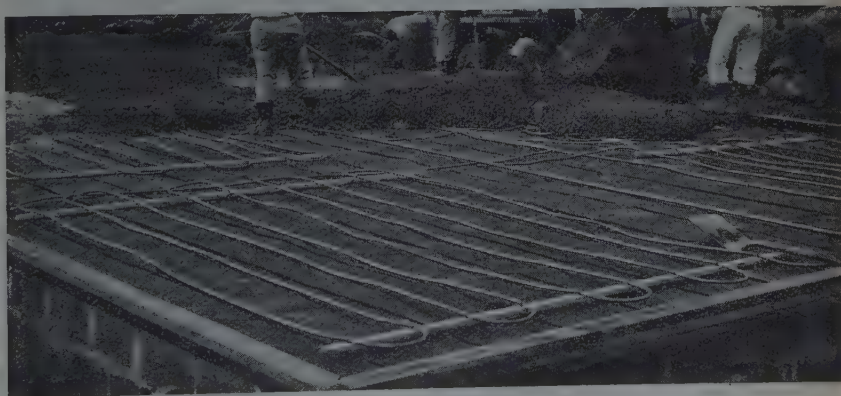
Coulage du béton sur tubes mal placés; défectuosité aggravée par la négligence des ouvriers marchant sur les tubes.
